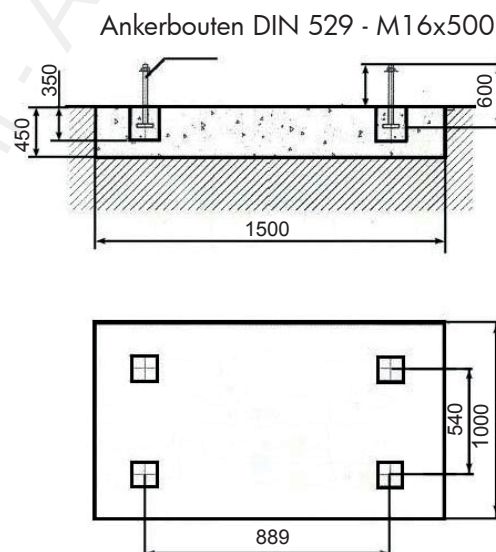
Funderingsplan (Afmetingen in mm)
